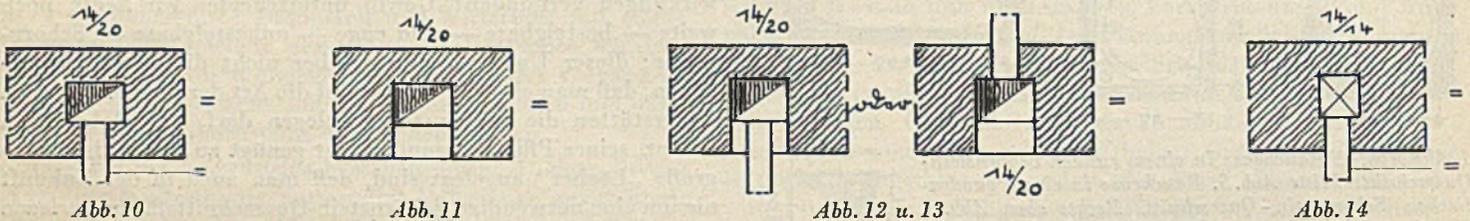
Grundrißkennzeichen eines Kohleschornsteins in den einzelnen Stockwerken. Grundrißkennzeichen des Verbindungsstückes zwischen Feuerstätte und Schornstein = Rauchrohr. Abb. 11. Grundrißkennzeichen eines Kohleschornsteins mit Angabe der Schornsteinsohle und der Reinigungsöffnung zur Rußentnahme; sollte eine zweite Reinigungsöffnung im Dachgeschoß vorzusehen sein, so drückt sich dieses Sinnbild ebenfalls klar aus, weil es im Dachgeschoßgrundriß wiederkehrt. Abb. 12 u. 13. Grundrißkennzeichen eines Kohleschornsteins mit Angabe des Rauchrohrs, der Schornsteinsohle und der Reinigungsöffnung. Abb. 14. Grundrißkennzeichen eines Gasschornsteins in den einzelnen Stockwerken. Grundrißkennzeichen des Verbindungsstückes zwischen Feuerstätte und Schornstein = Abgasrohr.
